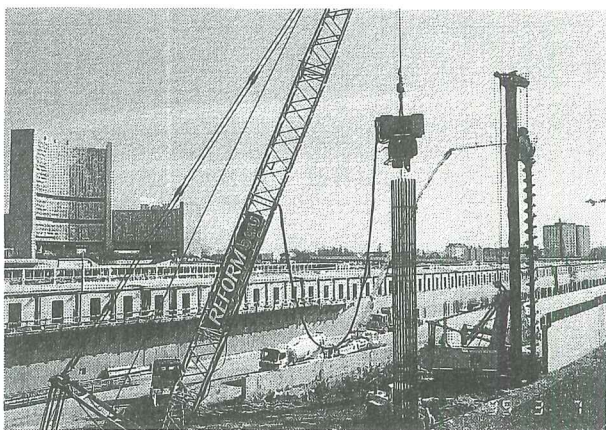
CFA杭施工状況 (ウィーン、国連本部ビル前)
